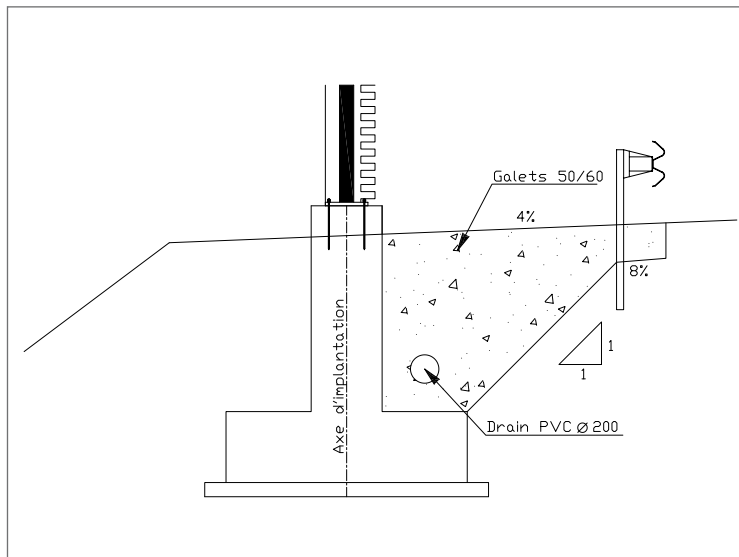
Exemple de création d'un assainissement en rive d'une plateforme existante
